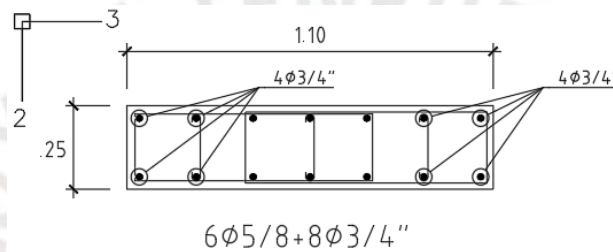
Detalle de refuerzo a flexo-compresión de la columna C-01.
